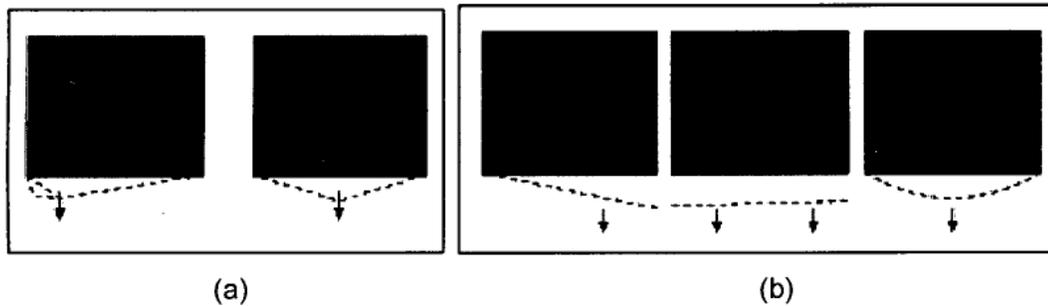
(a) fisuras en muros debido a un asentamiento puntual en la cimentación. (b) fisuras en muros debido a un asentamiento uniforme en la cimentación
